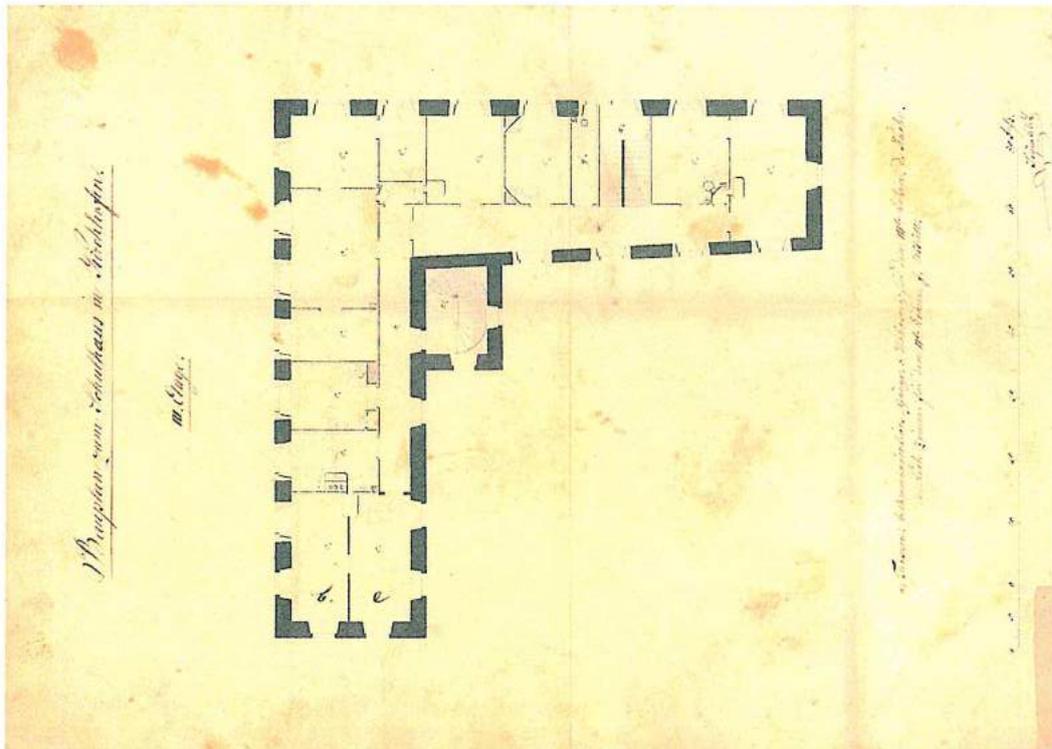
Bauplan zum Schulhaus in Kirchhofen, II. Etage,
